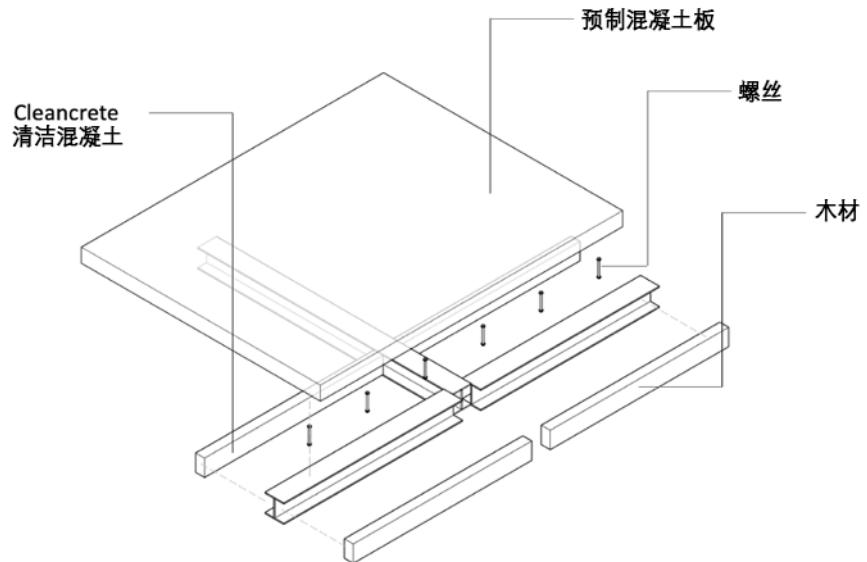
建议采用可拆卸的「混凝土楼板-钢梁」连接构件施工做法轴测图。©ZHAW
